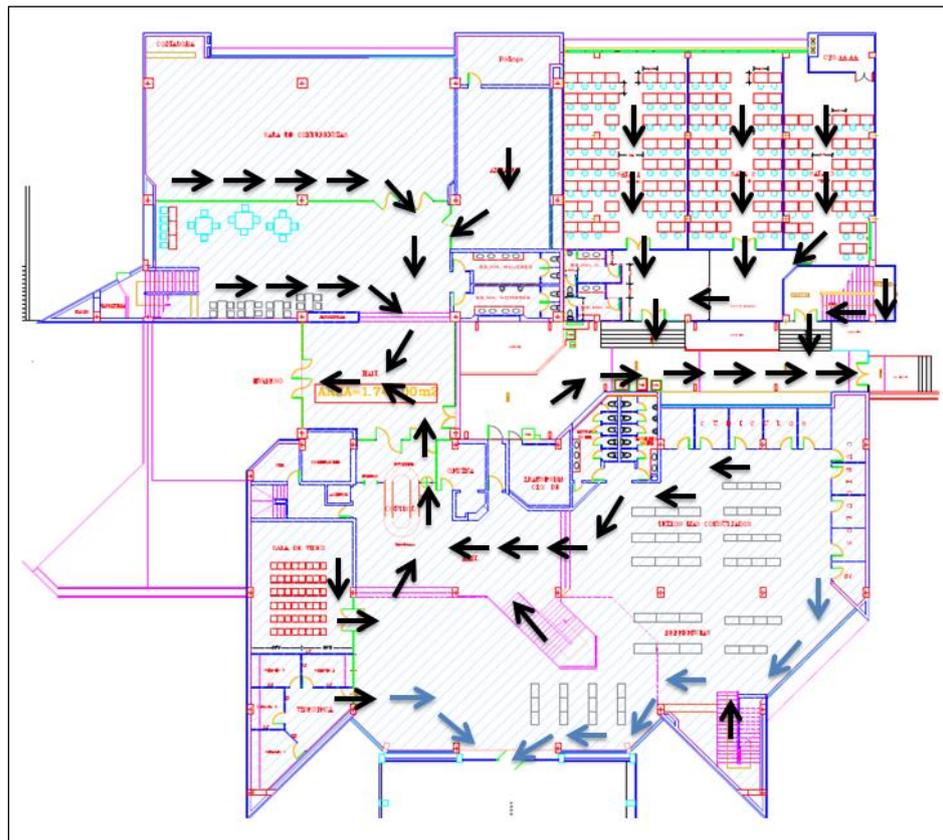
Ruta de Evacuación, Planta Baja, Zona 1 y 2
